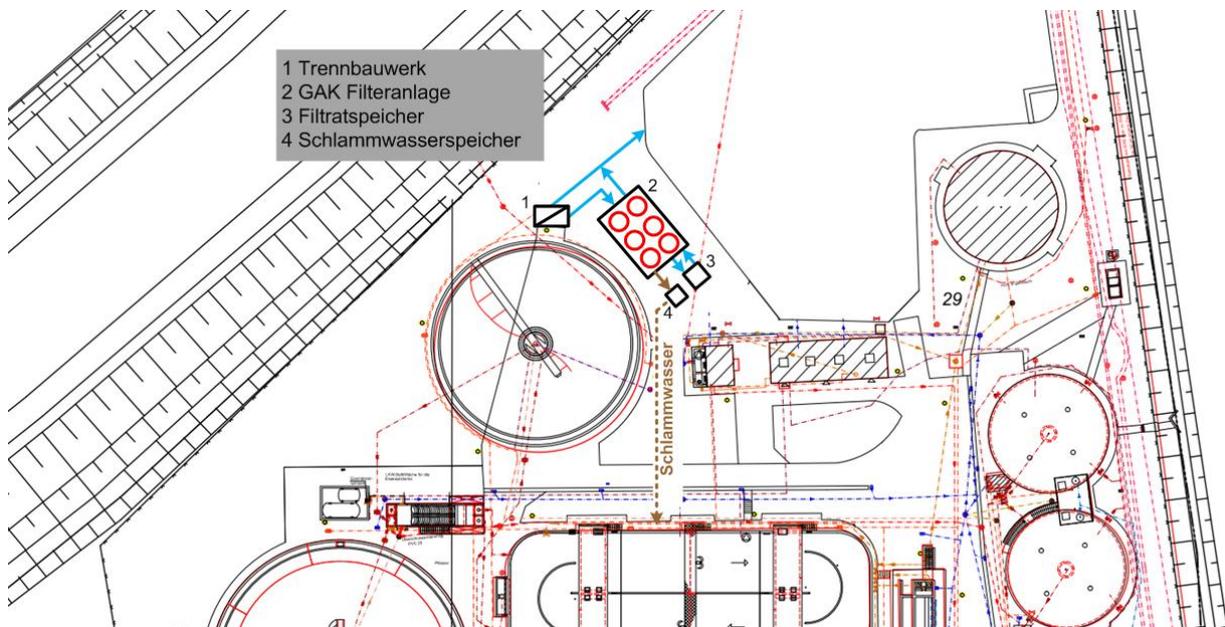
Lageplan GAK-Filteranlage auf der Münster-Geist
